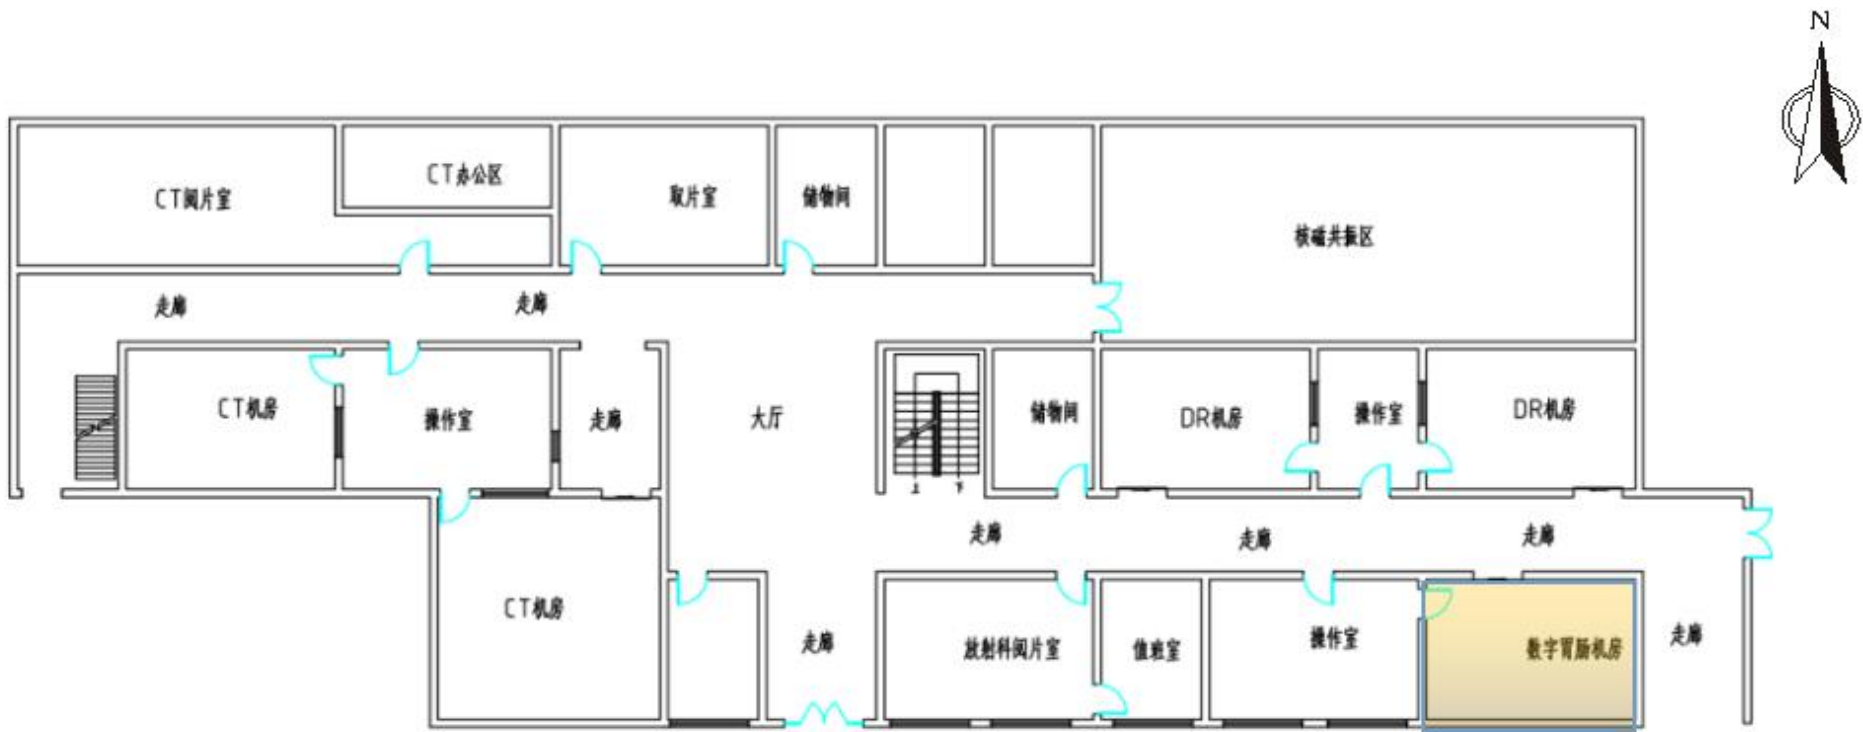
本项目 DSA 机房所在 1 号楼（一层）平面布置示意图
